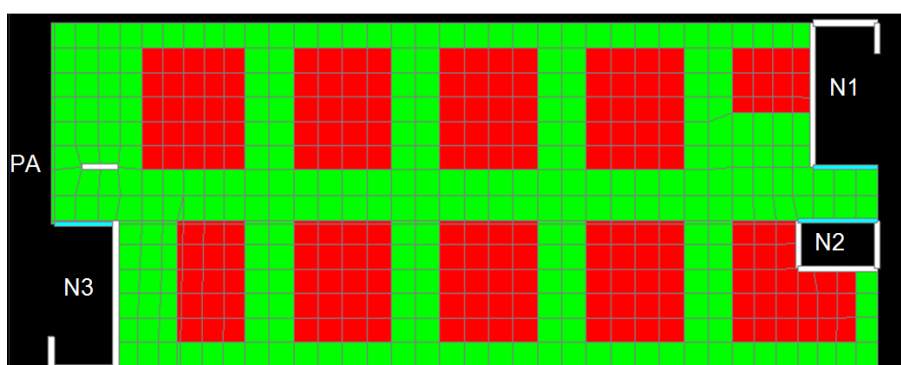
Vista em planta do piso tipo do modelo B (SAP2000)
